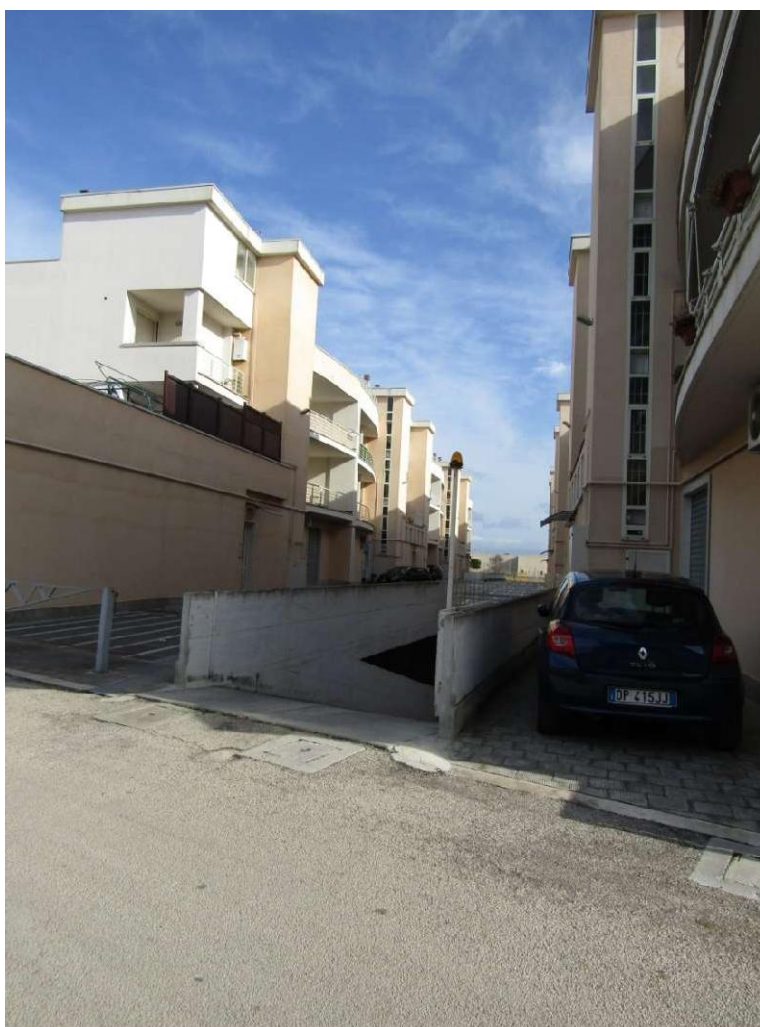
LOTTO 13 – LOCALE DEPOSITO IN FOGGIA – FABBRICATO B – RAMPA DI ACCESSO AI BOX INTERRATI
